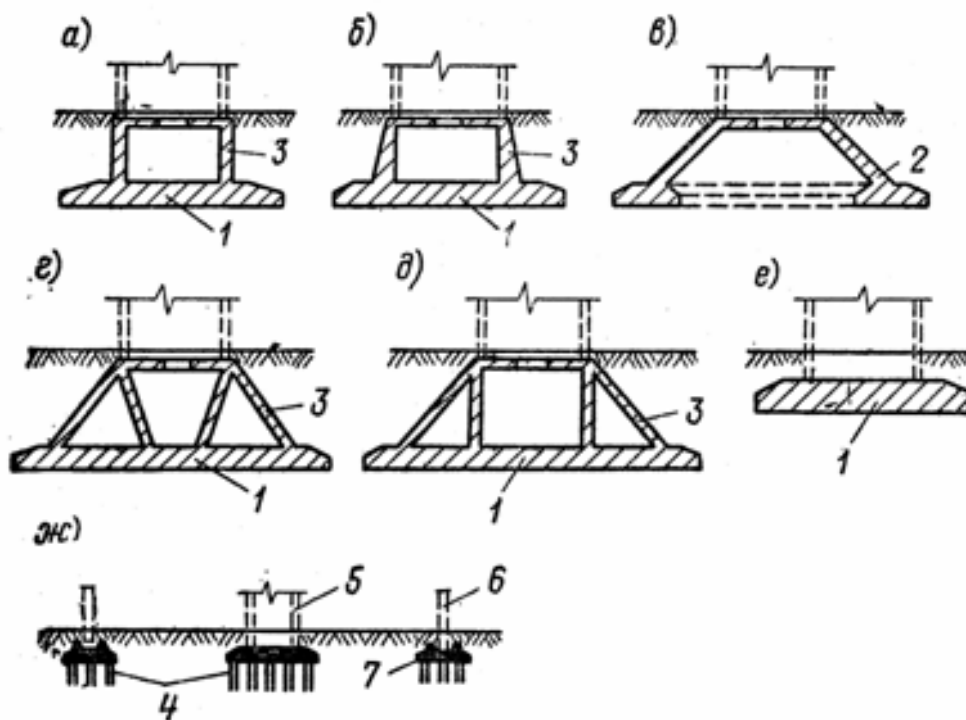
Типи фундаментів водонапірних башт: 1 – суцільна фундамента плита; 2 – кільцева фундамента плита; 3 – підвищена частина фундамента; 4 – палі; 5 – центральна опора; 6 – стояки по периметру башти; 7 – окремі фундаменти
